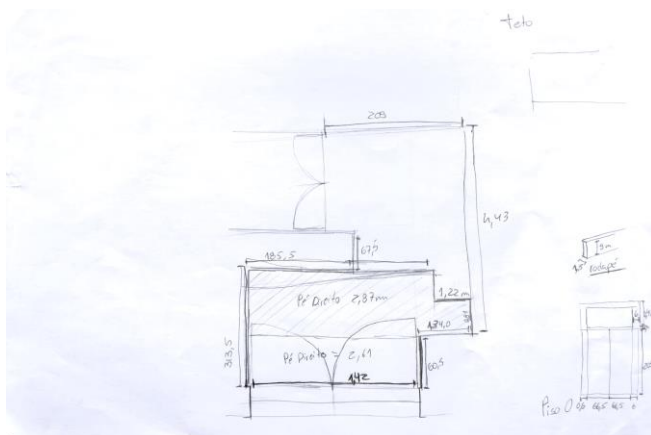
Esboço planta piso 0. Fonte: Ana Ferreira.
